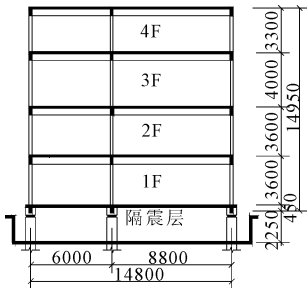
Ⅰ-Ⅰ剖面图(单位:mm)
